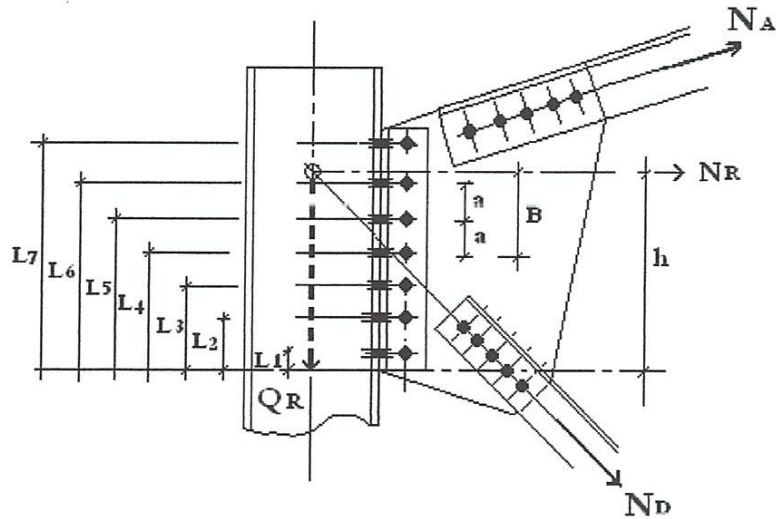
attaches des pieds de poutres treillis encastrées.
